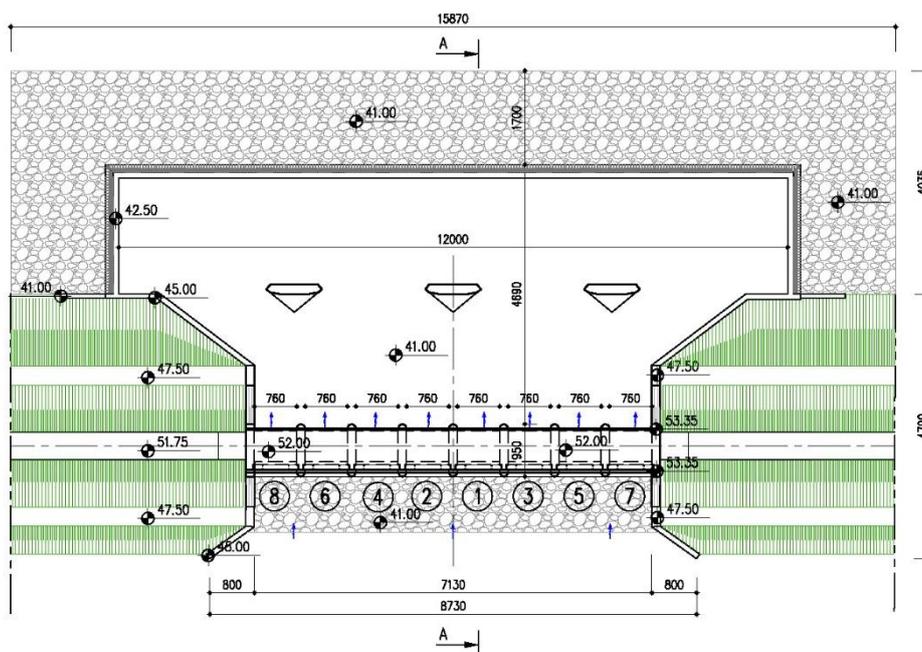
Pianta del manufatto di alimentazione dell'invaso laterale.
